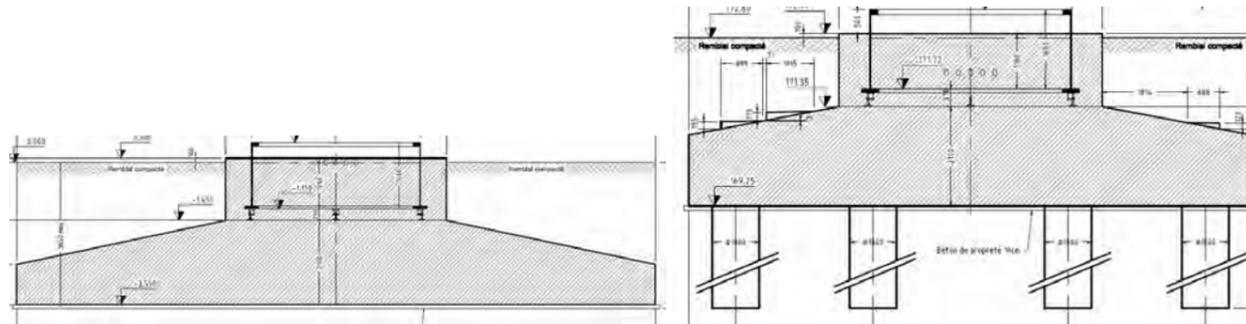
vue en coupe d'une semelle d'éolienne superficielle (à gauche) et sur pieux (à droite)
